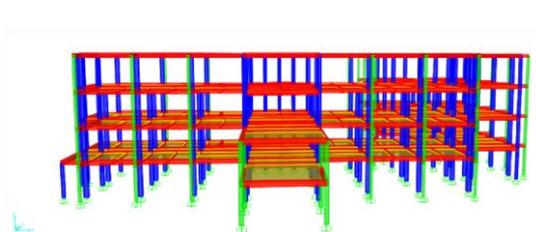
SAP 2000 V22 Section pada Plat Lantai
